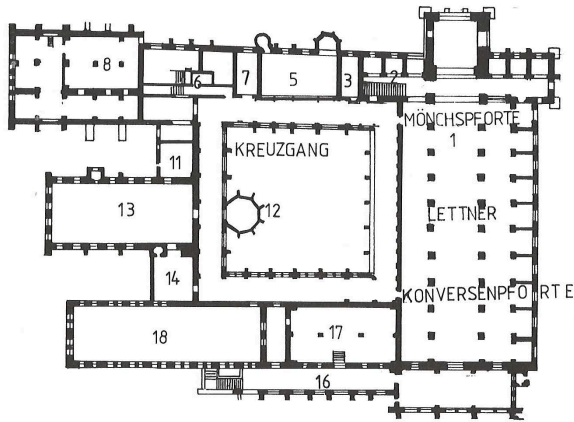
Maulbronn (gegr. 1147), Grundriß der Klausur (13. Jahrhundert ff.)
